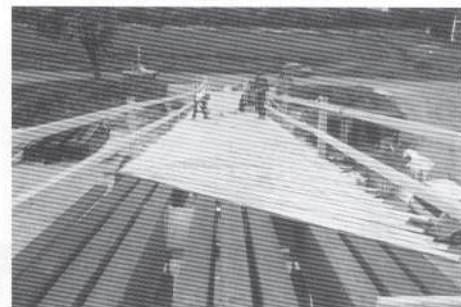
Erste Lage der Diagonalschalung über den Spannlägern
